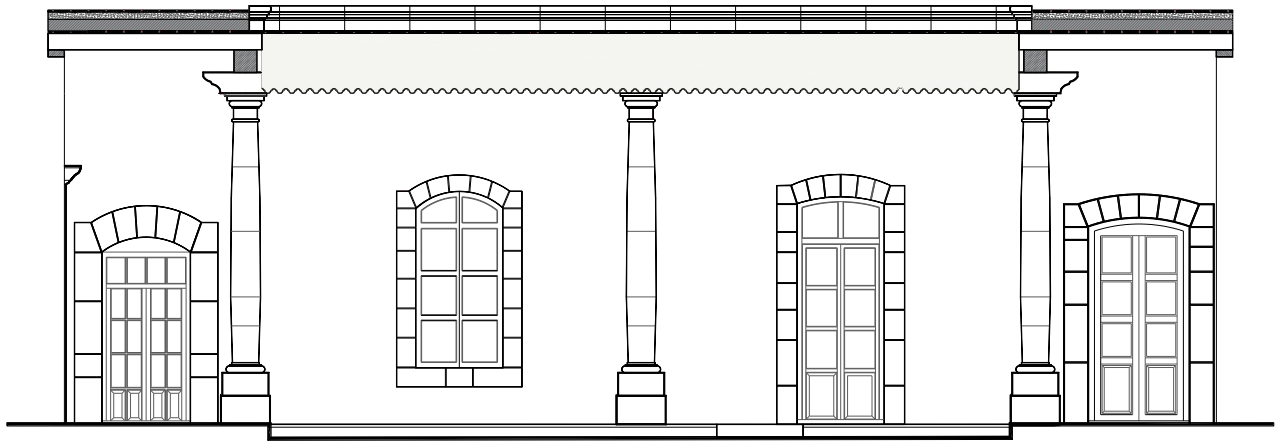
Vista del corte del corredor sur de la vivienda.
